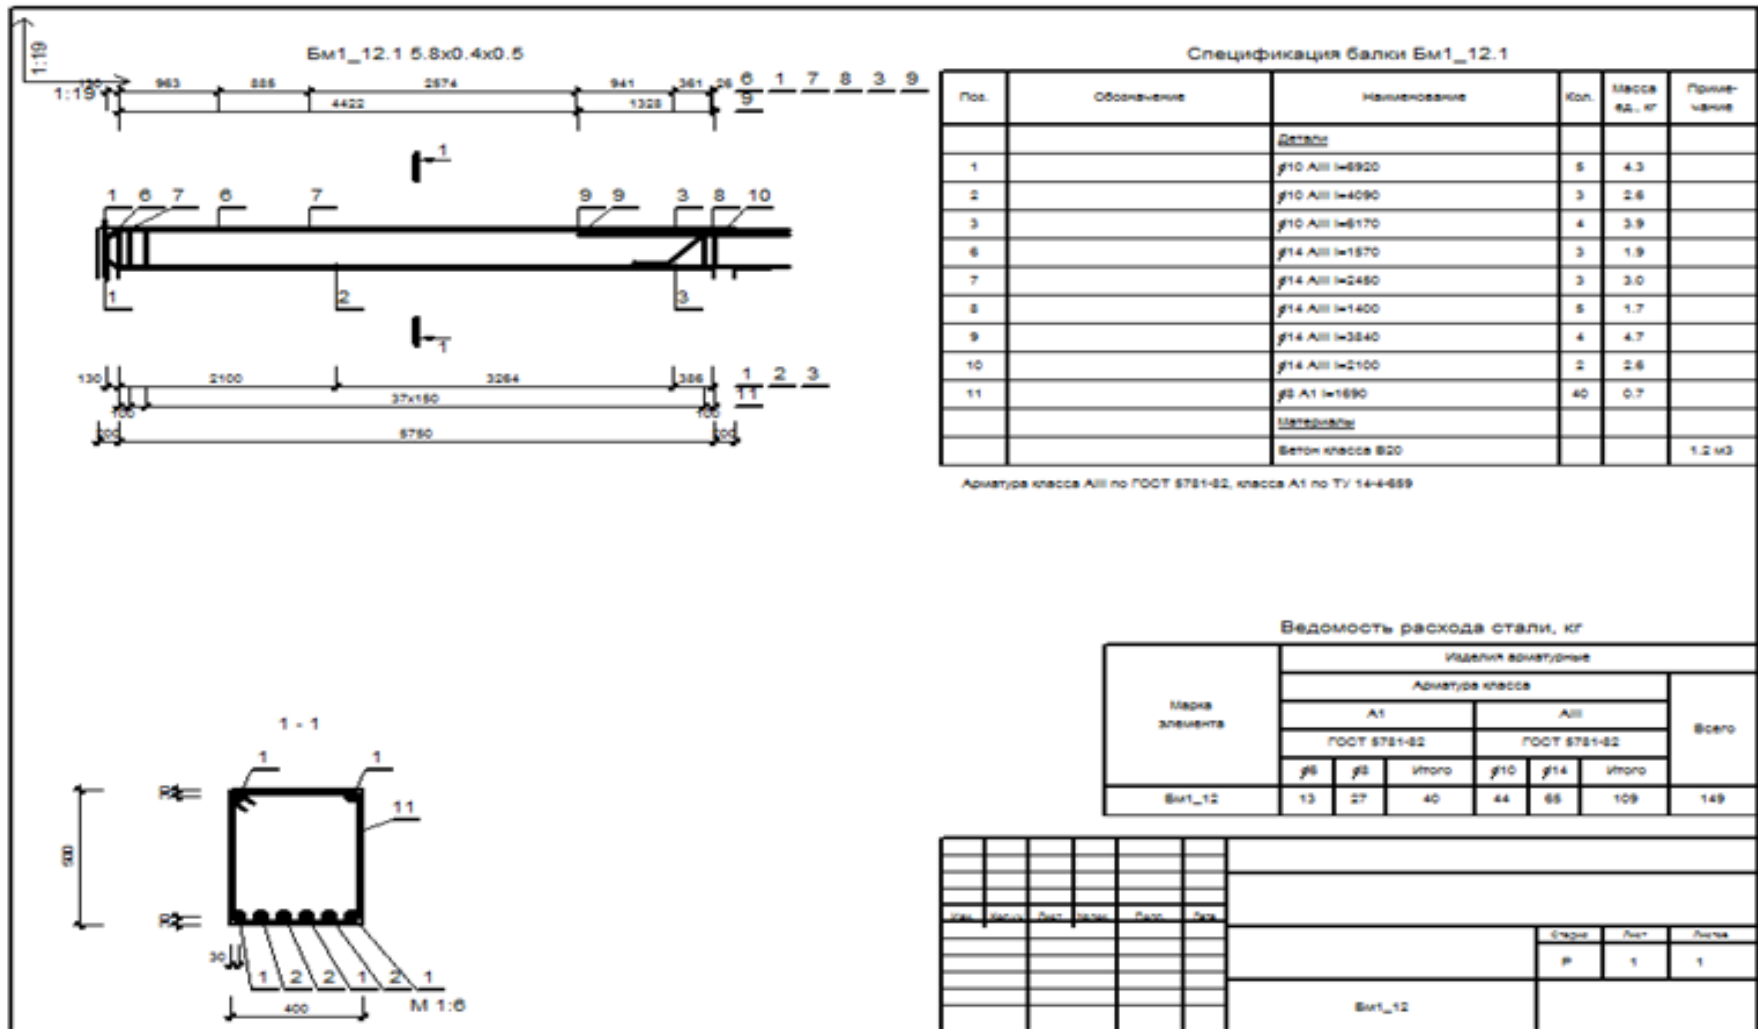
Перший поверх. Балка Б1-12. Креслення робочого проекту
